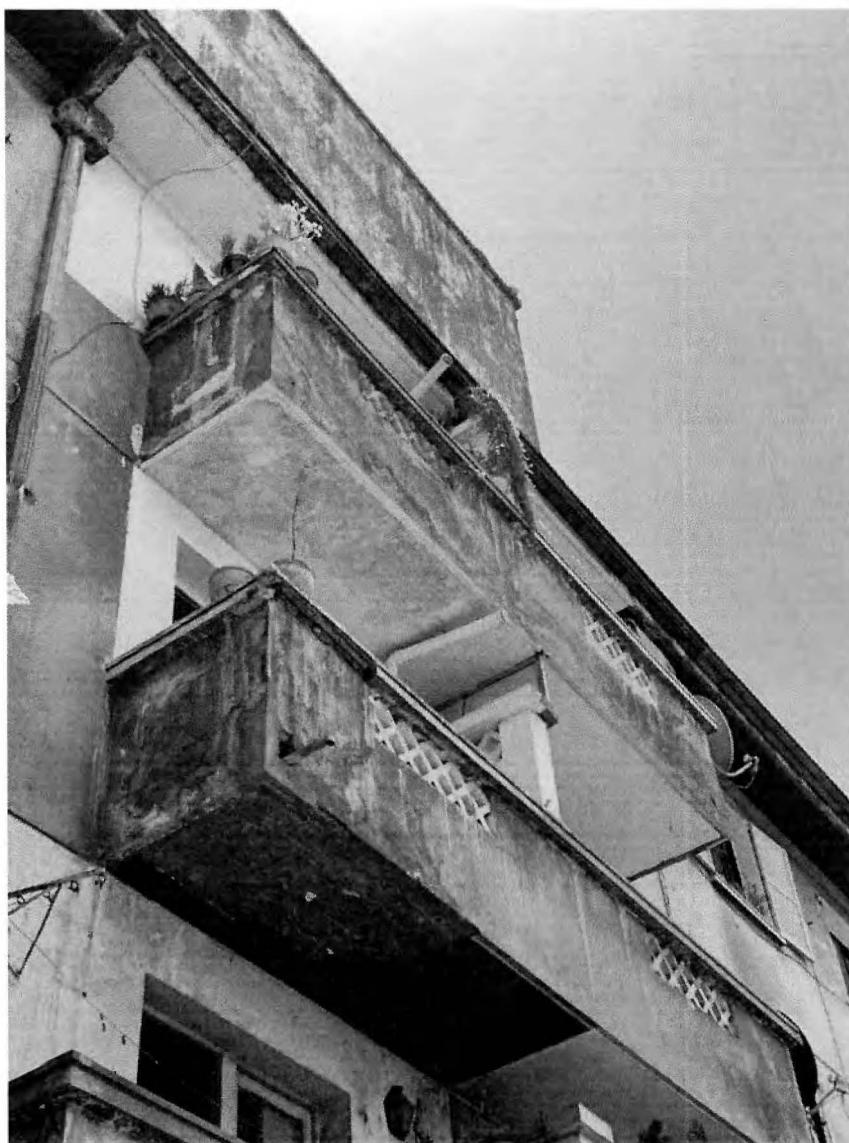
Desprendimiento y fisuramiento de losa y muro en balcón en patio interior, fachada norte.
